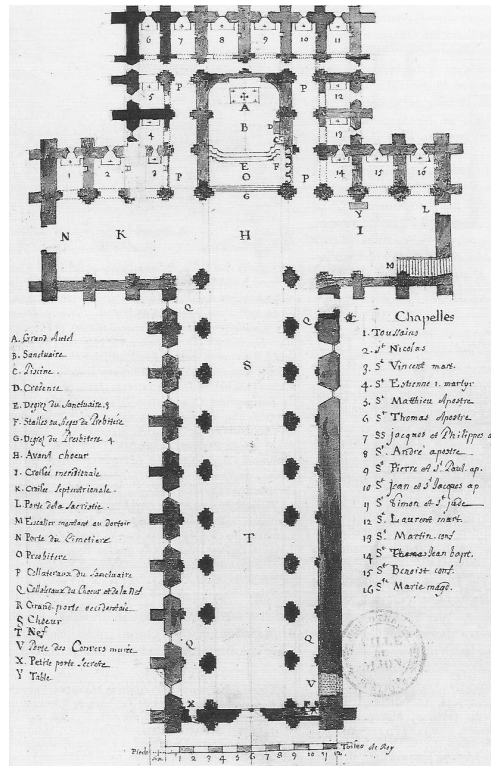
Cîteaux, Grundriss (nach 1150).
